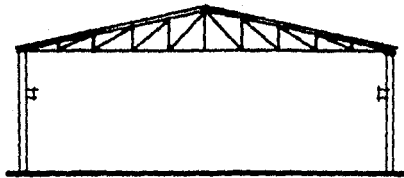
ESTRUCTURA A BASE DE ARMADURA Y COLUMNAS
